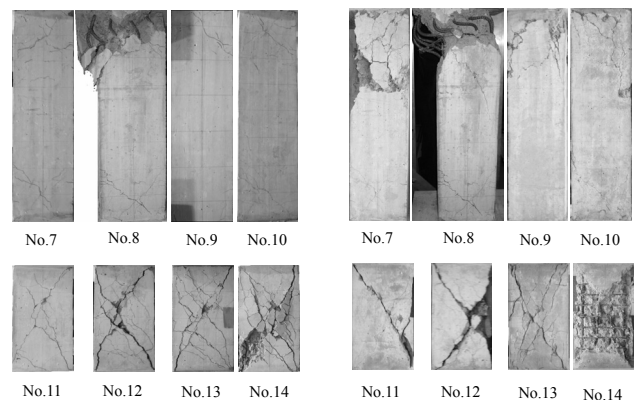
水平加力後のひび割れ 写真2 鉛直加力後のひび割れ
